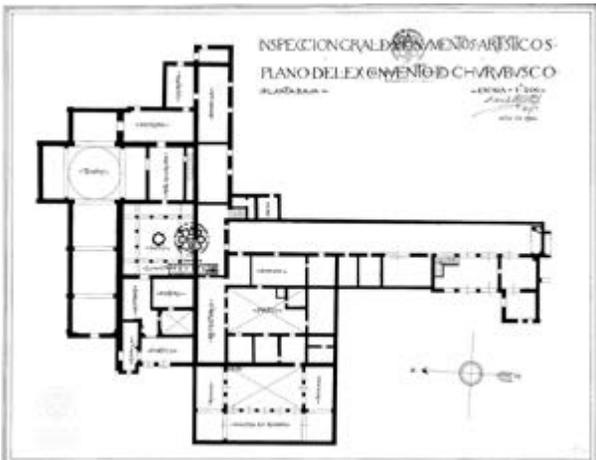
Plano del Convento de Churubusco (planta baja), firmado por el arquitecto Manuel Ituarte, 1920, AHJE, exp. Santa María de los Ángeles, ex Convento de Churubusco, CNMH/INAH.
